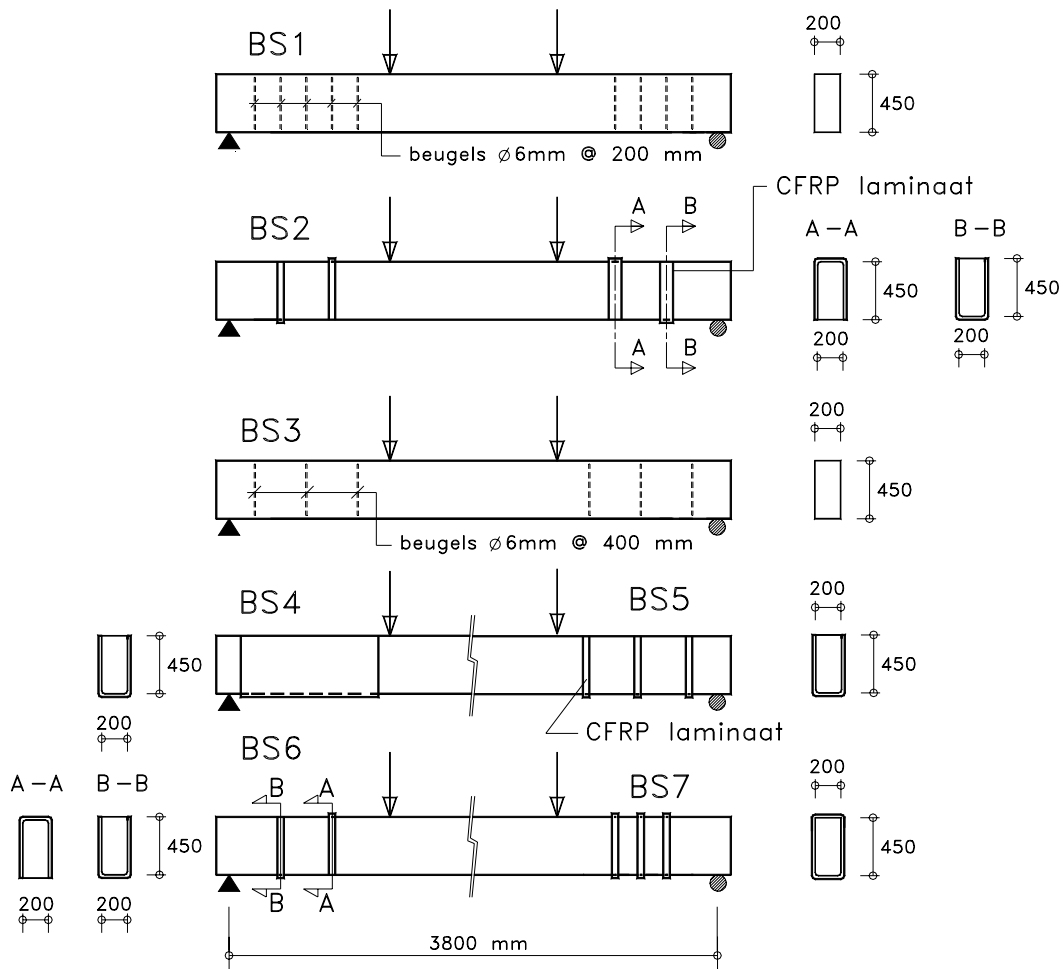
Proefopstelling gewapende betonbalken versterkt in dwarskracht
